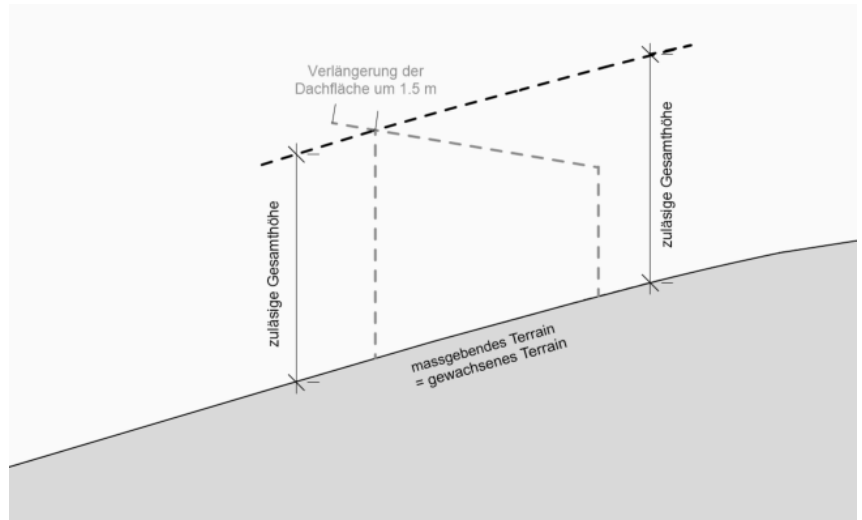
Dachvorsprünge: Verlängerung der Dachfläche um 1.50 m
